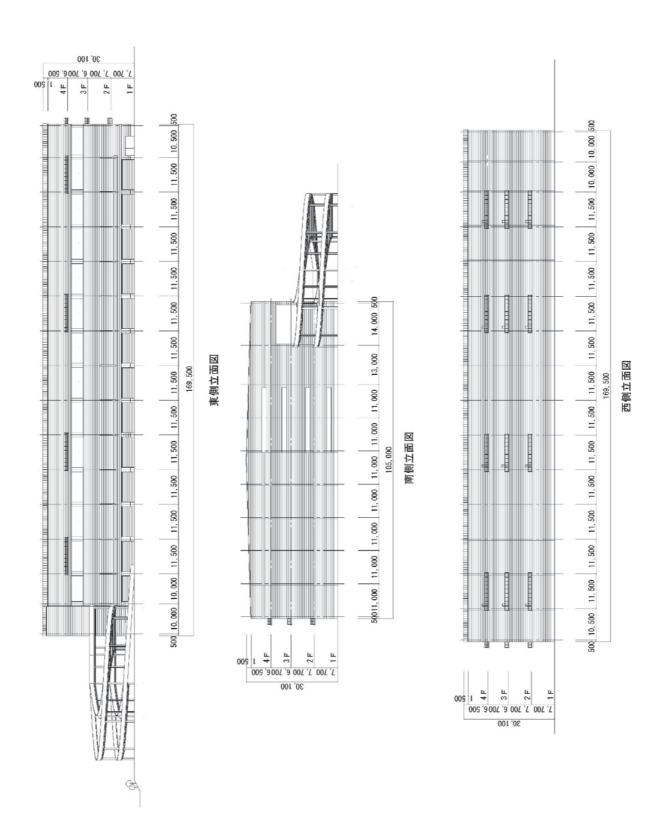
(1) 計画建物立面図 (業務地区 B)
